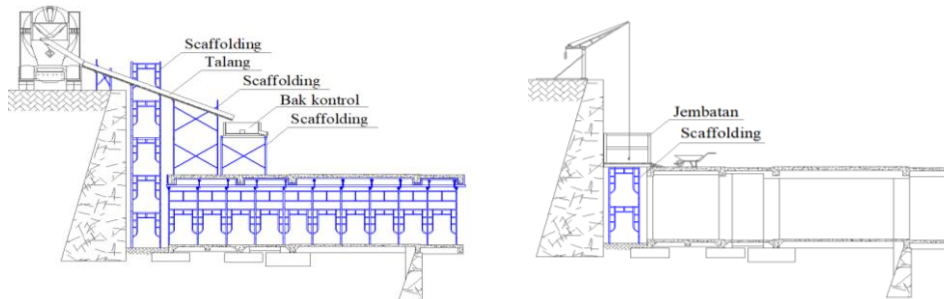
Pekerjaan pengecoran kolom, ring balok dan plat lantai
